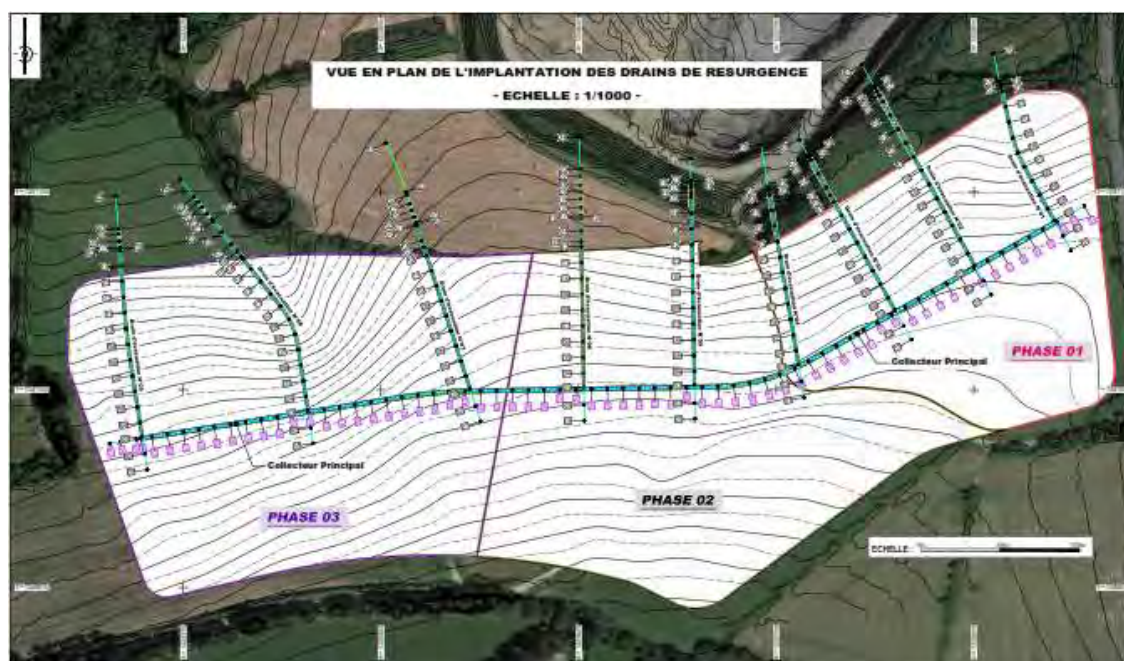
Vue en plan du dispositif de drainage des résurgences
